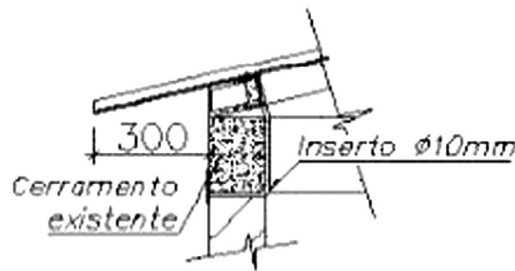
DETALLES DE ANCLAJE DE CUBIERTA A VIGA DE CERRAMIENTO.
